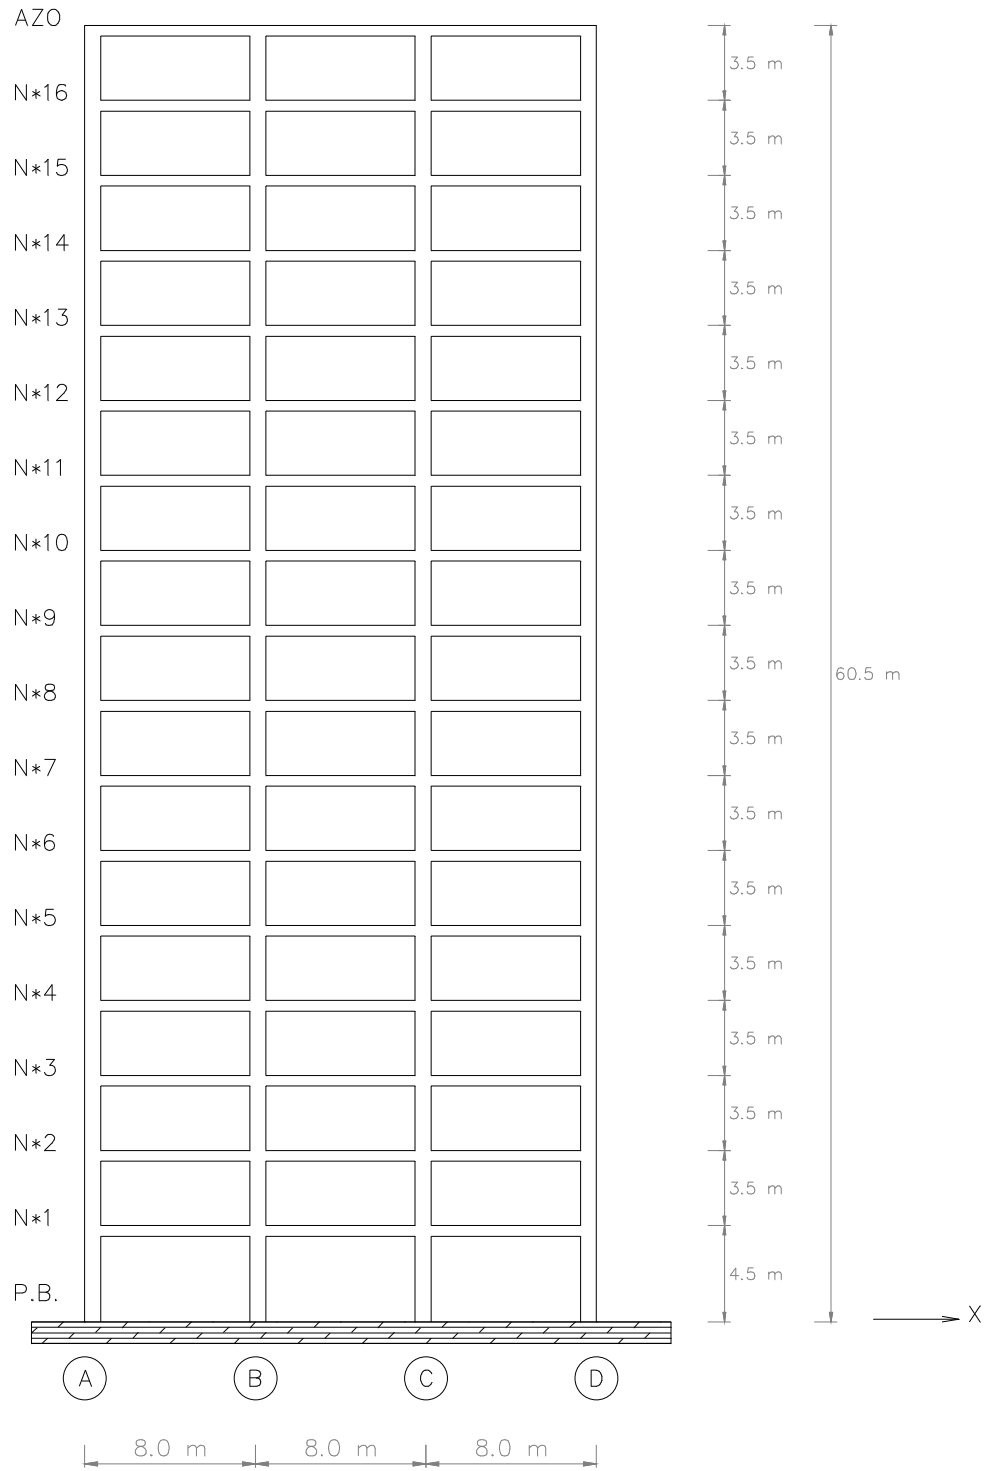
Corte en elevación de la estructura de 17 niveles
